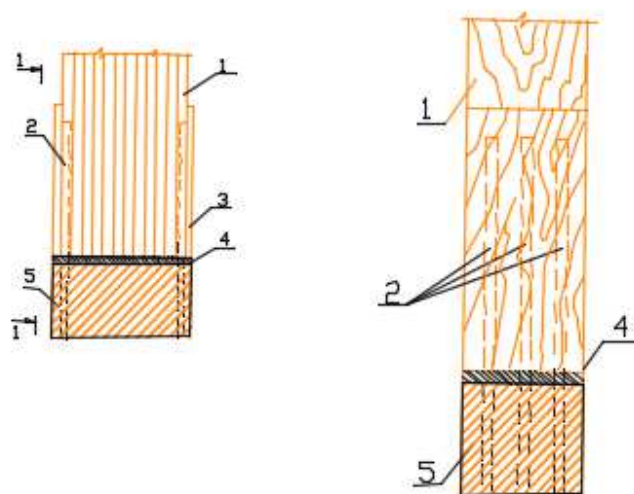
Опорный узел колонны с использованием железобетонного элемента, прикрепляемого к колонне на клеенных стержнях (ЦНИИПромзданий): 1 – клееная колонна; 2 – клеенные стержни; 3 – защитная доска; 4 – разделительная металлическая пластина; 5 – железобетонный пенек.
